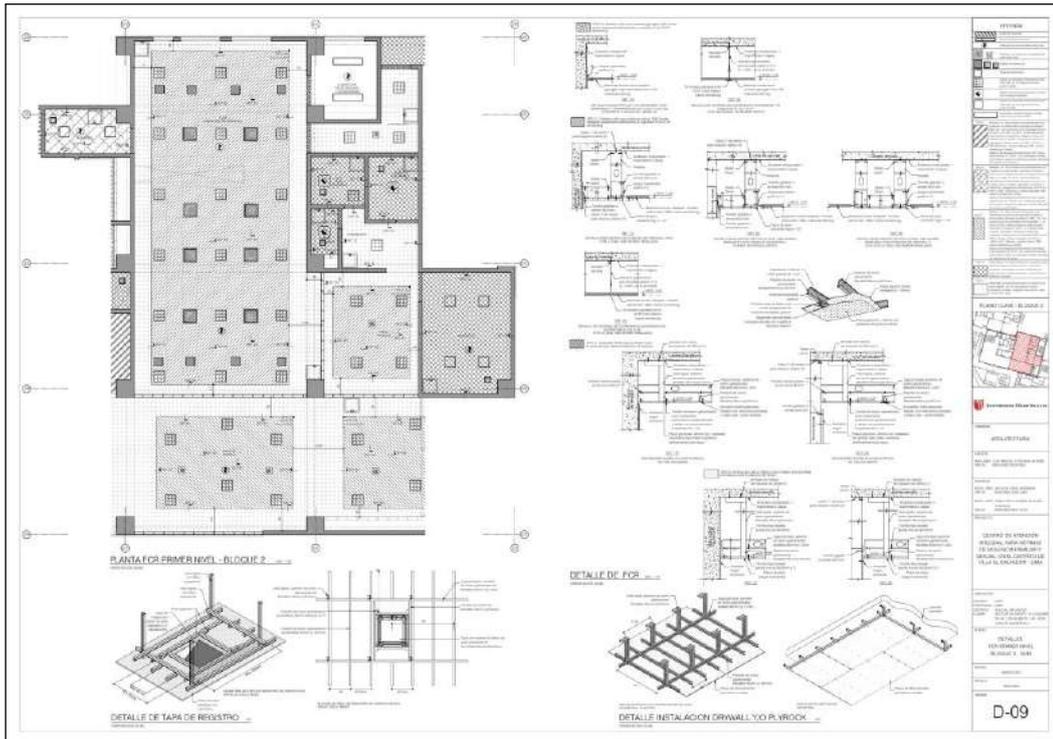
Plano de falso cieloraso en zona SUM primer nivel – bloque 2.
